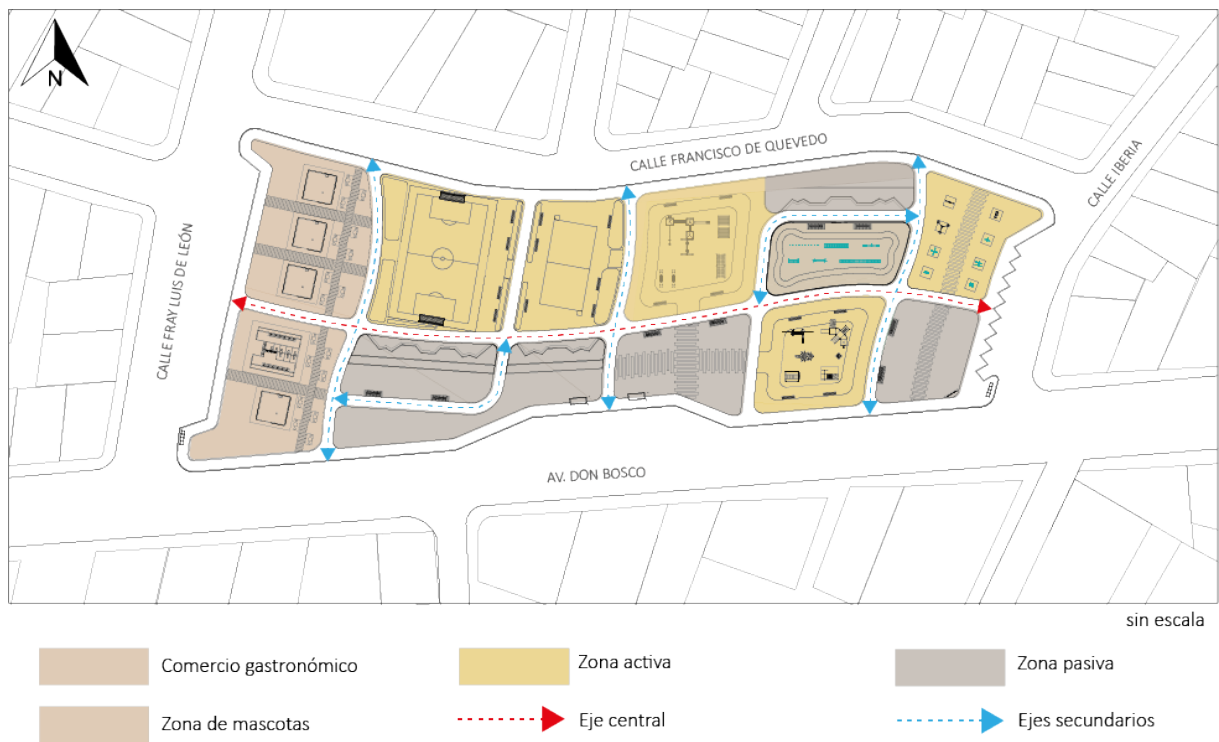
Configuración en planta de la propuesta de regeneración.
